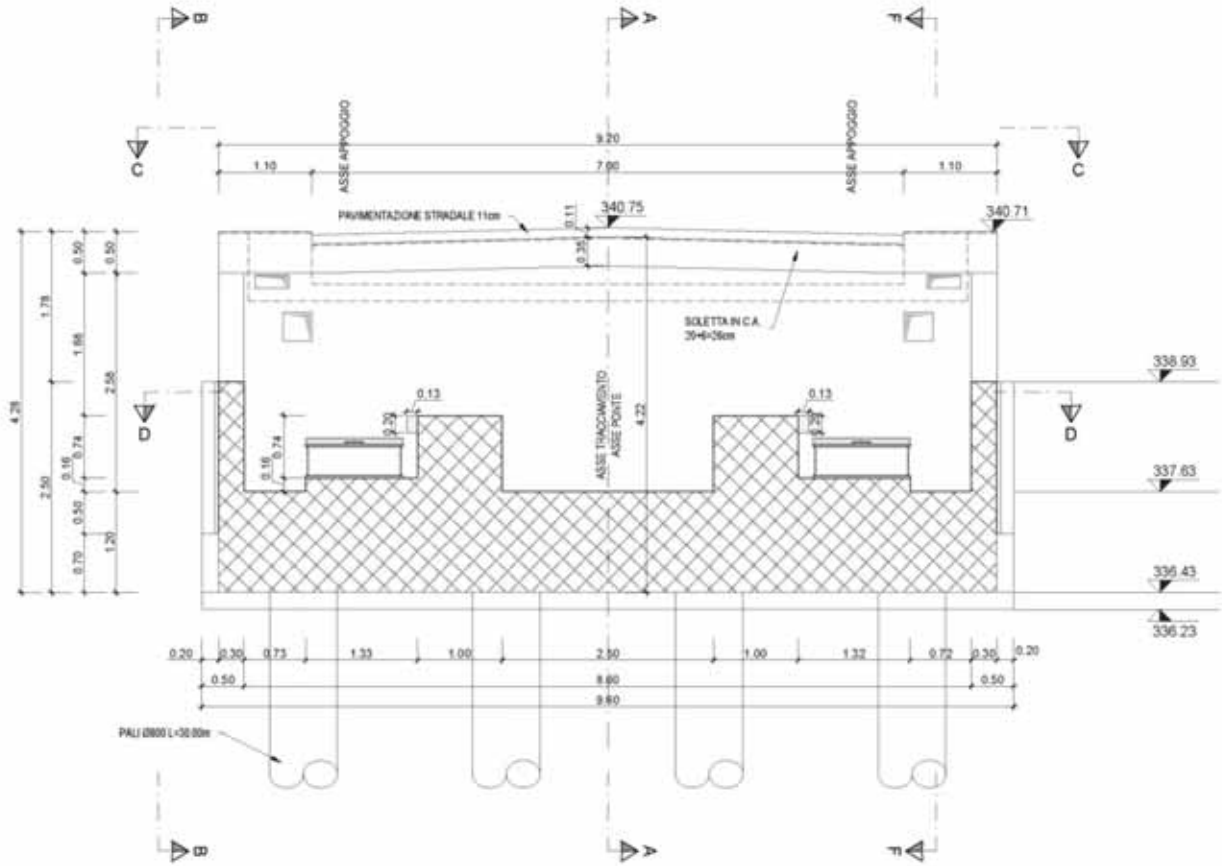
SPALLA B – Sezione longitudinale
